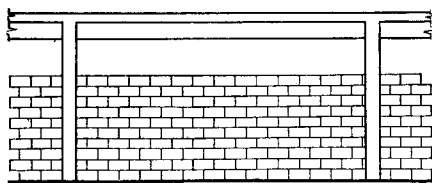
Перегородка, не доведенная до верха, для обеспечения вентиляции в условиях жаркого климата
